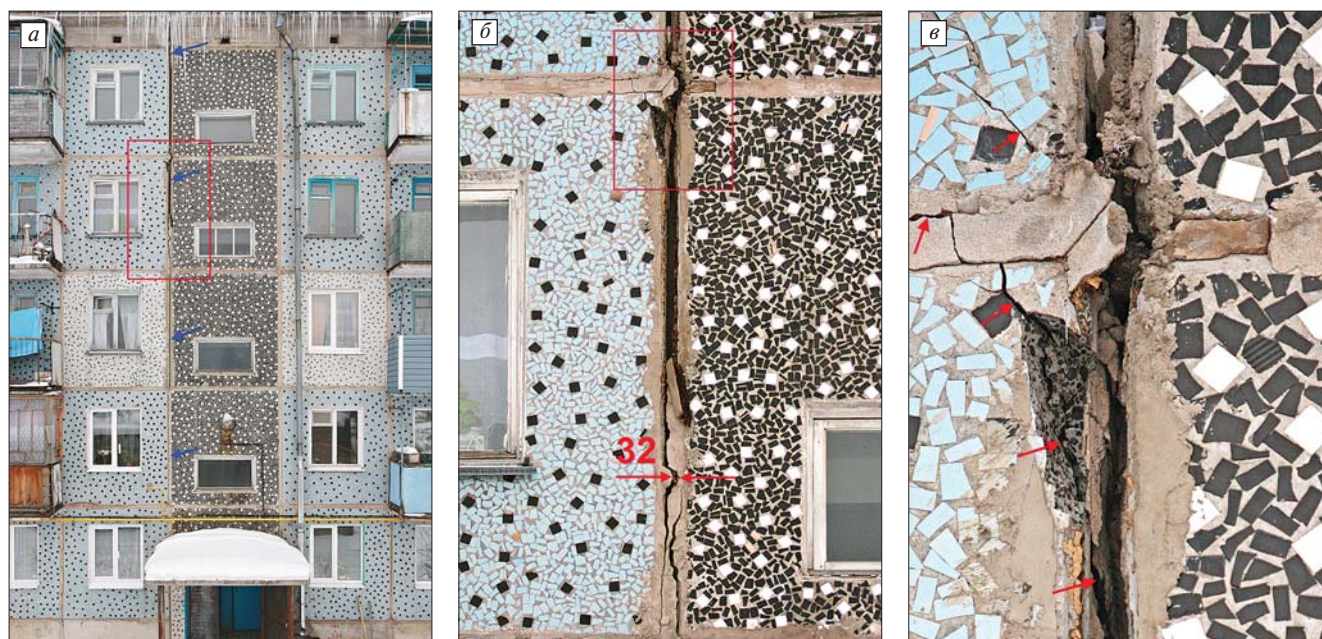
Фрагмент фасада в зоне второй секции здания (а); трещина указана синими стрелками. Укрупненный участок с трещиной шириной раскрытия 32 мм в уровне четвертого этажа выделен красным прямоугольником (б). Характерные трещины в зоне крепежных стальных закладных деталей (в)
